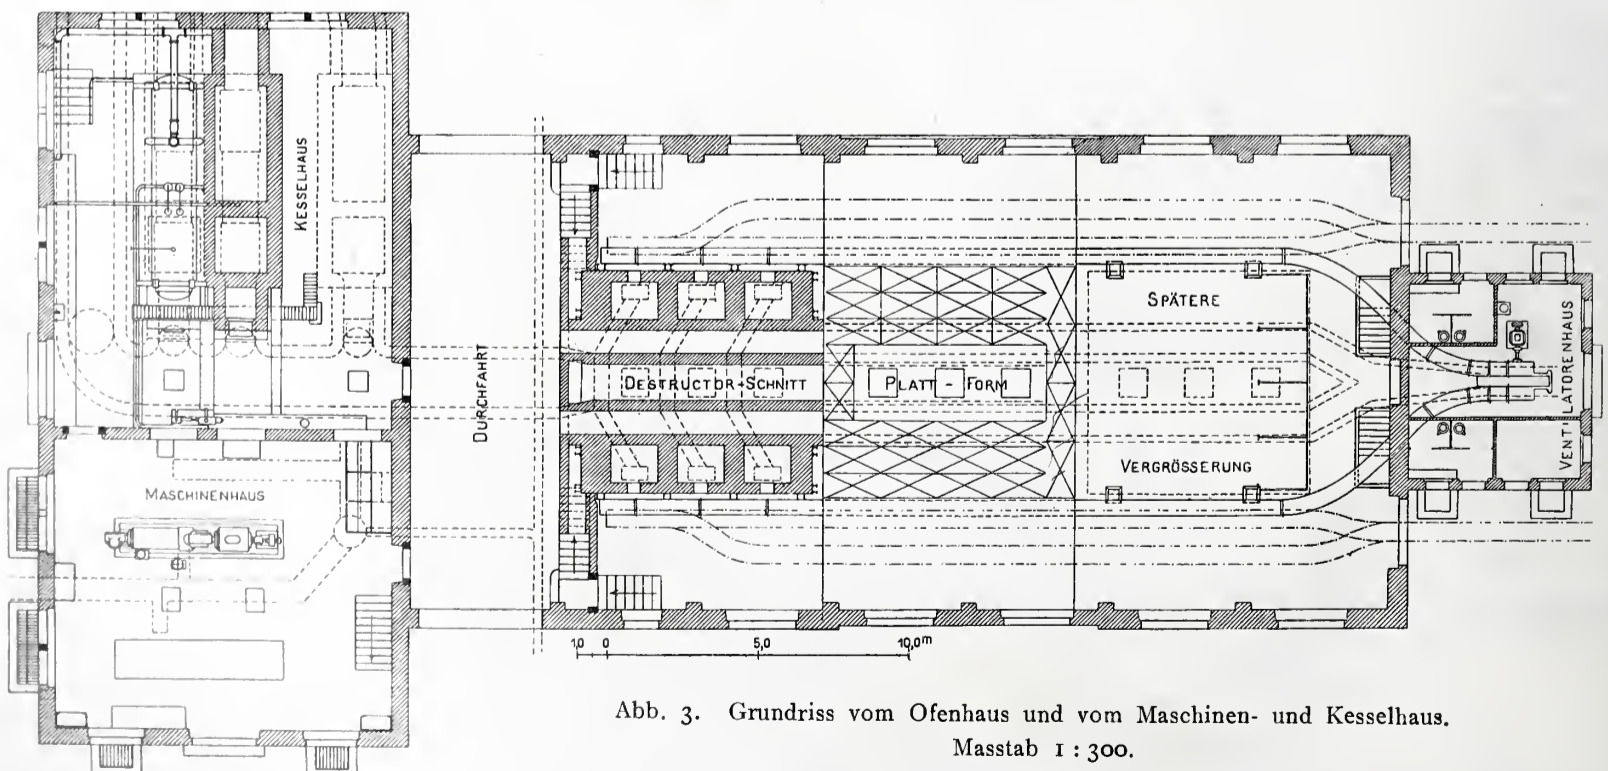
Grundriss vom Ofenhaus und vom Maschinen- und Kesselhaus.
